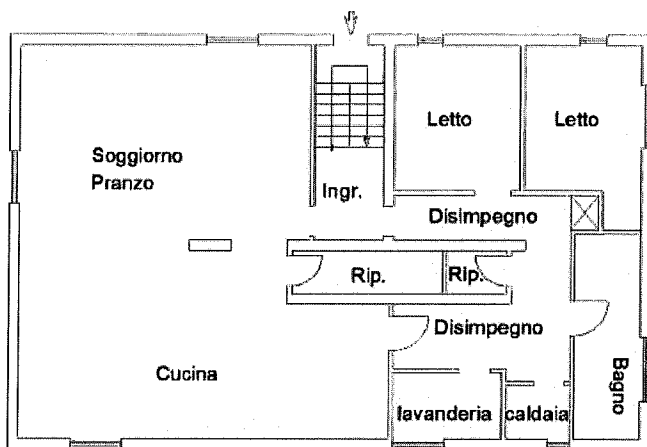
Planimetria Piano Seminterrato – Situazione esistente
